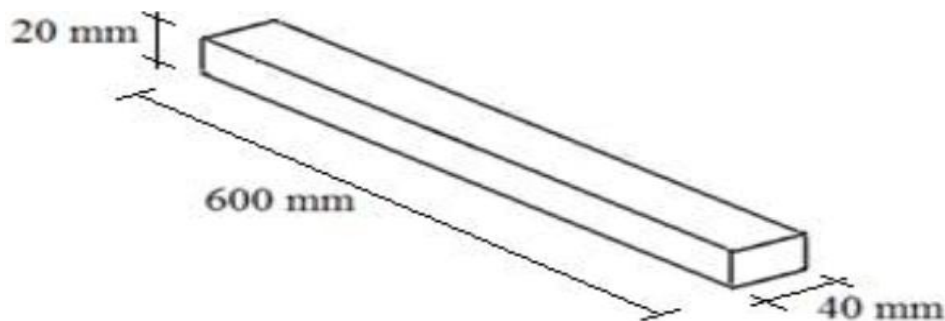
Dimensiones adoptadas para las vigas probetas.
